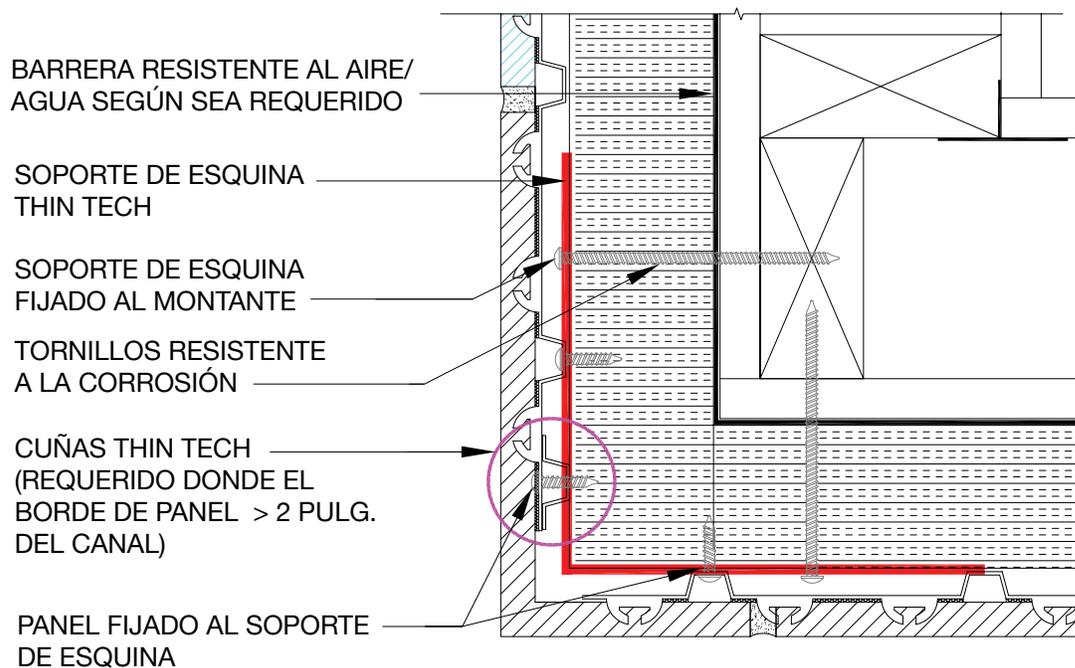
DETALLE SOBRE LA FIJACIÓN DE SOPORTE DE ESQUINA
